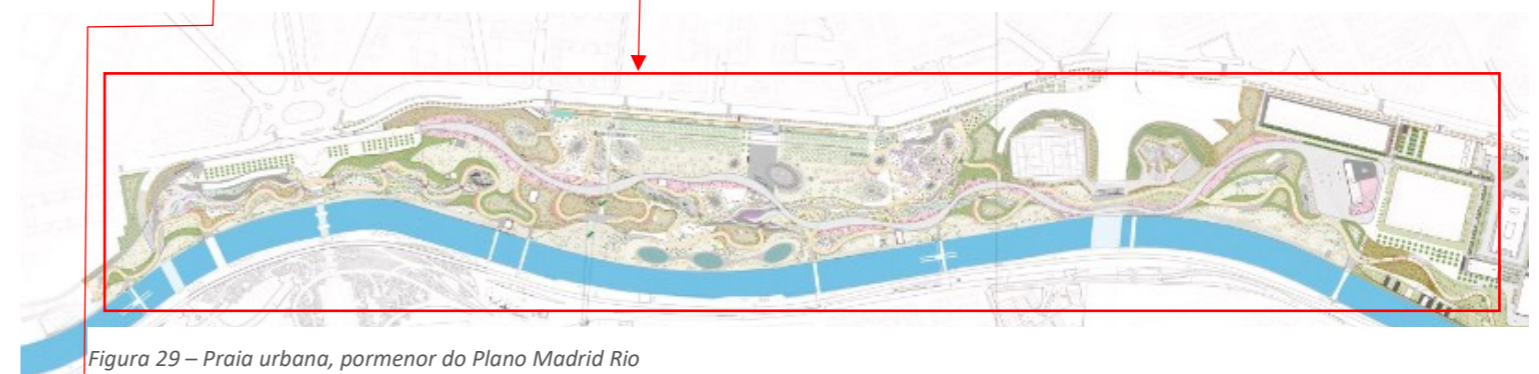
Praia urbana, pormenor do Plano Madrid Rio
